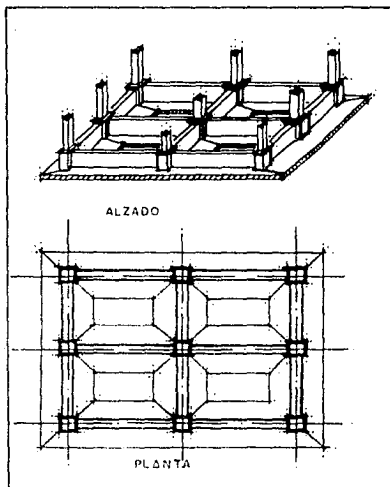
ZAPATAS CONTINUAS EN AMBAS DIRECCIONES
